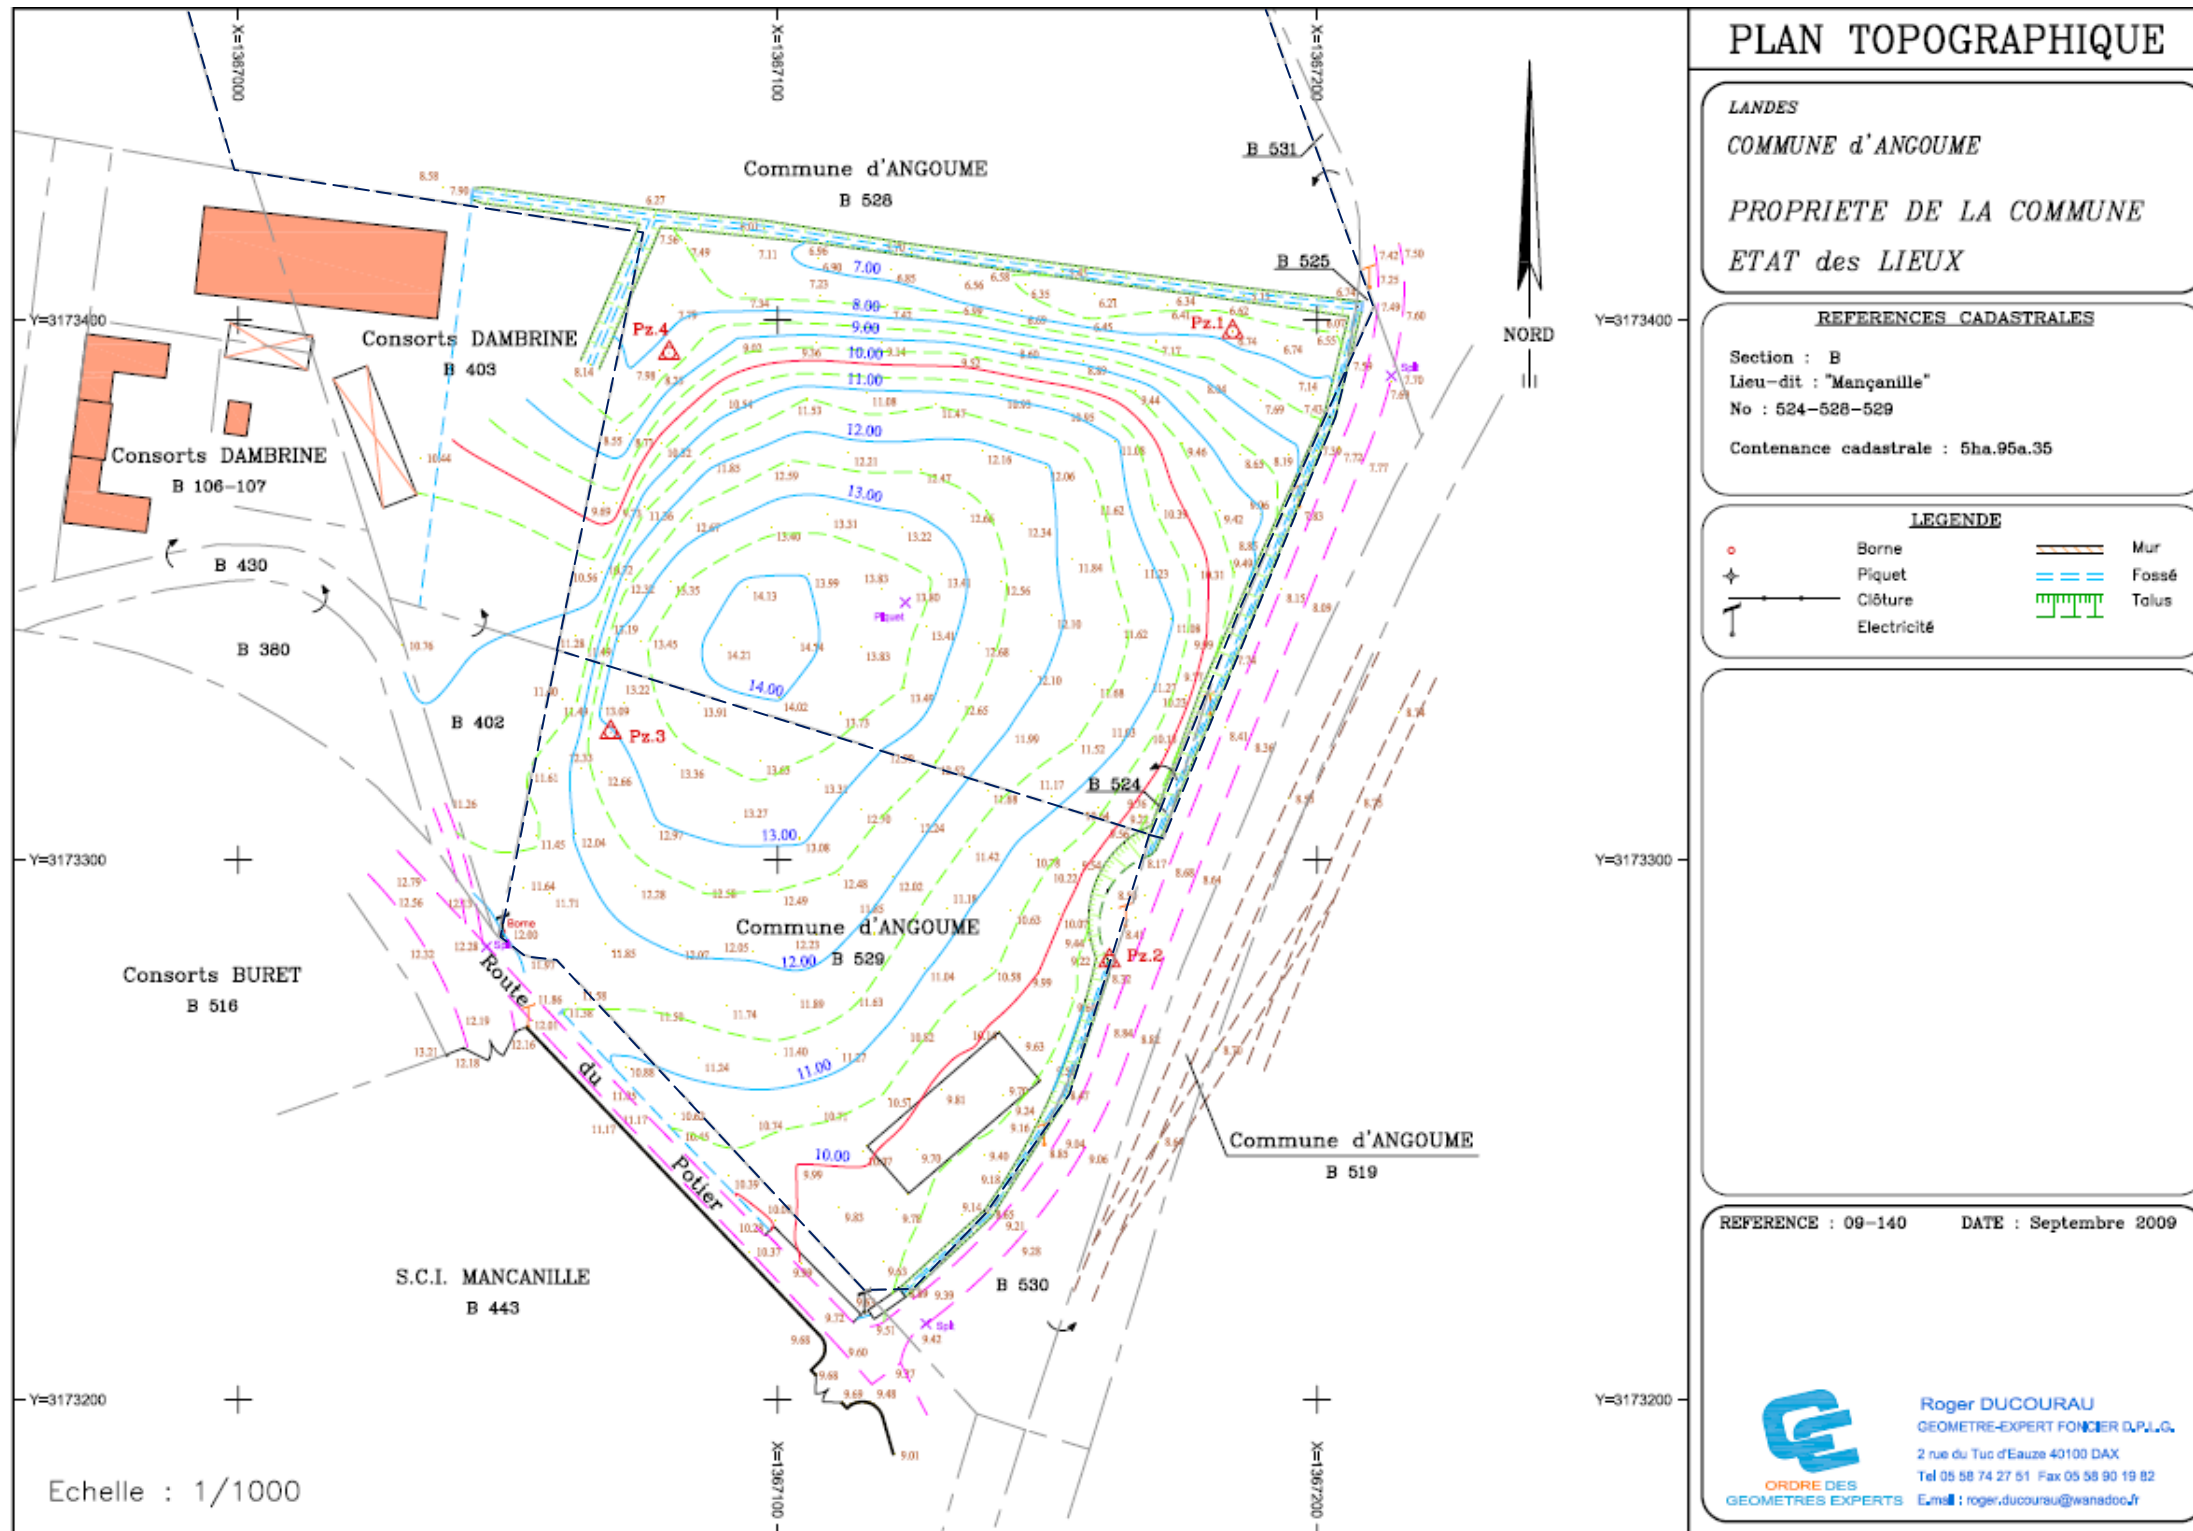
Plan topographique avant réalisation des travaux – Parcelles cadastrales
